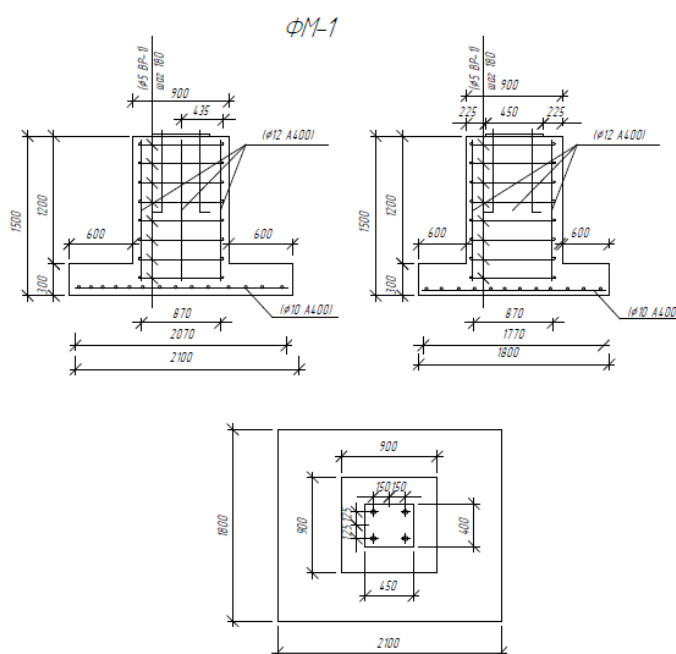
Схема расположения арматурных изделий в фундаментах ФМ1
